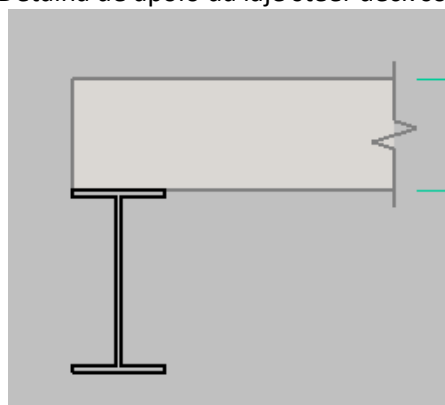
Fôrmas e detalhes para lajes steel-deck.
